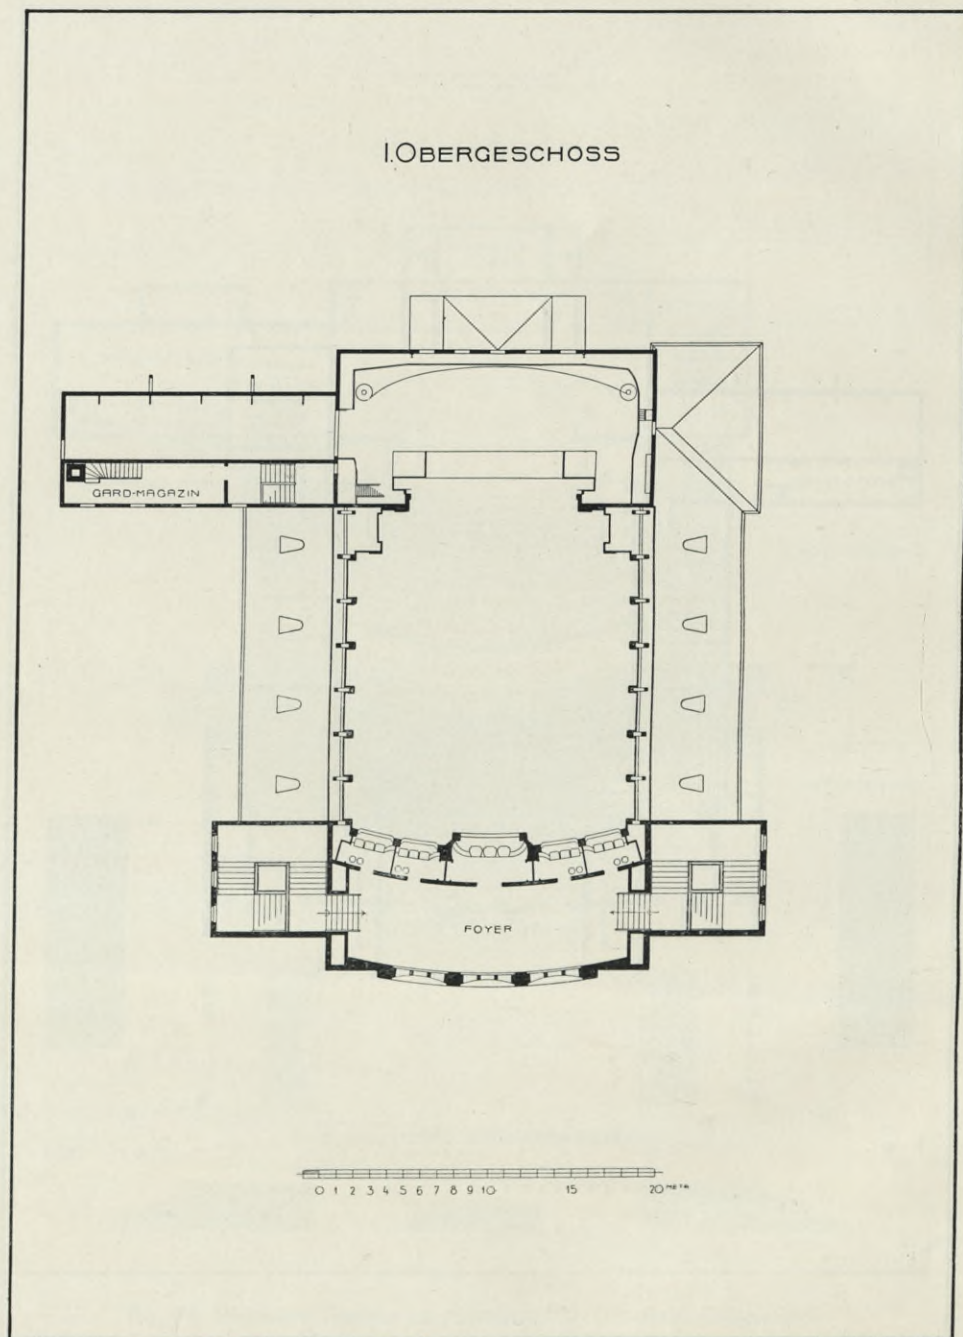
Künstler-Theater zu München. <sup>121)</sup> Grundriß 1. Obergeschoß.
